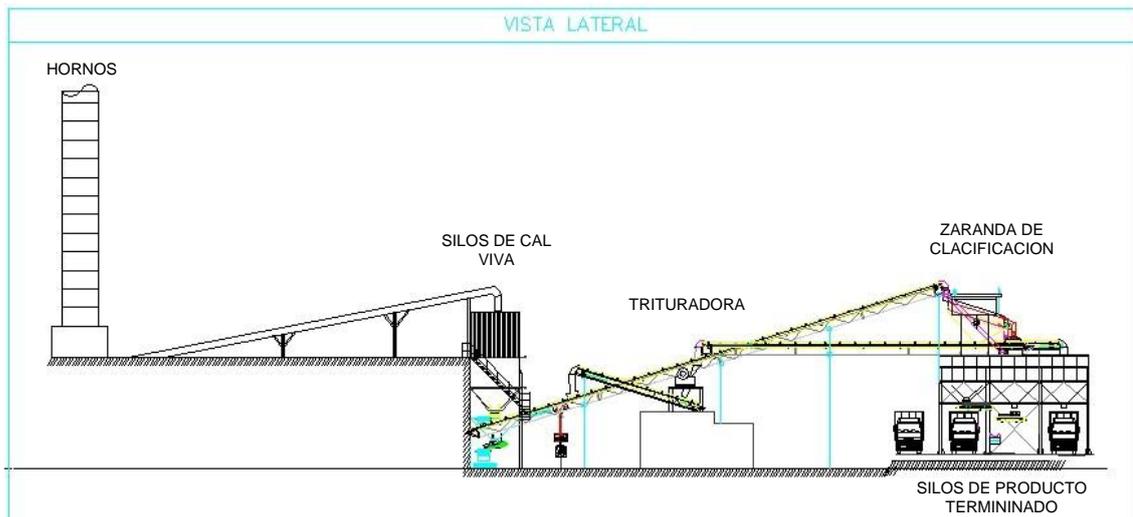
Vista lateral de la planta de procesamiento de cal dolomítica actual.
